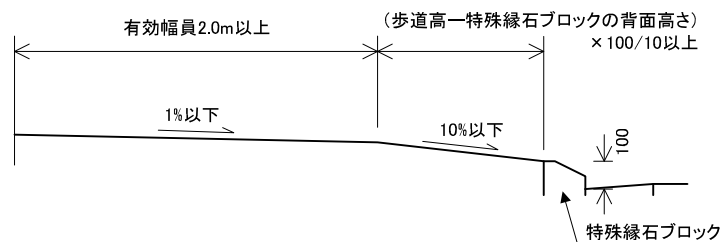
III-47 歩道内すりつけ構造断面図(特殊縁石ブロック)
